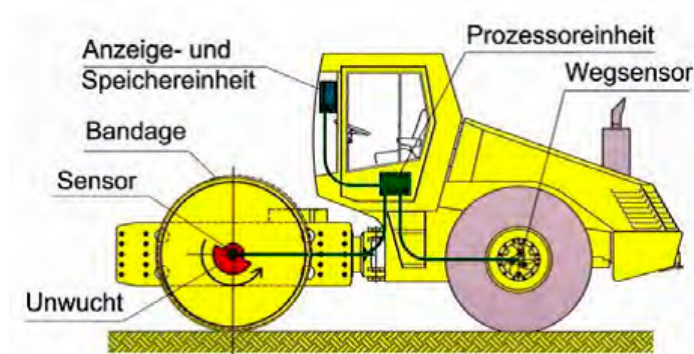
Schema der walzenintegrierten flächenhaften Verdichtungskontrolle (FDVK)
